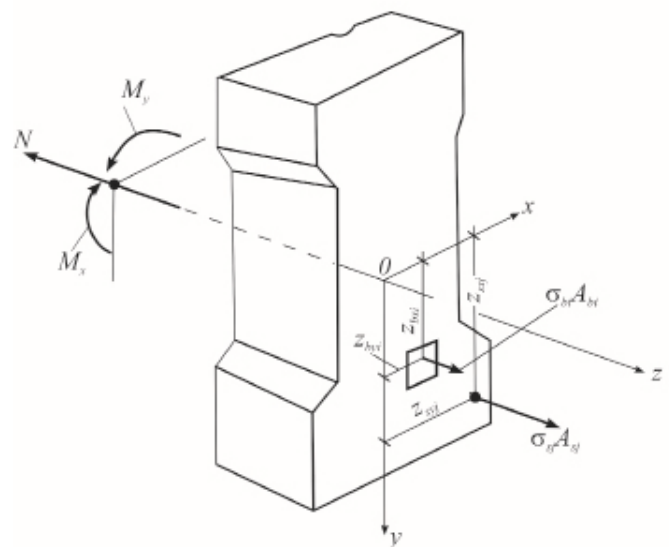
Расчётная схема нормального сечения железобетонного элемента
